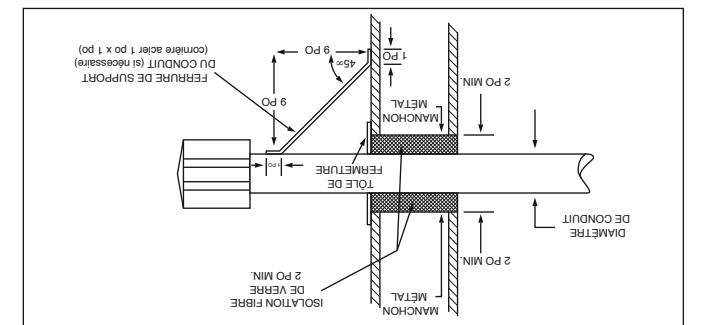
Construction d'une traverse à travers une paroi combustible et support de cheminée
